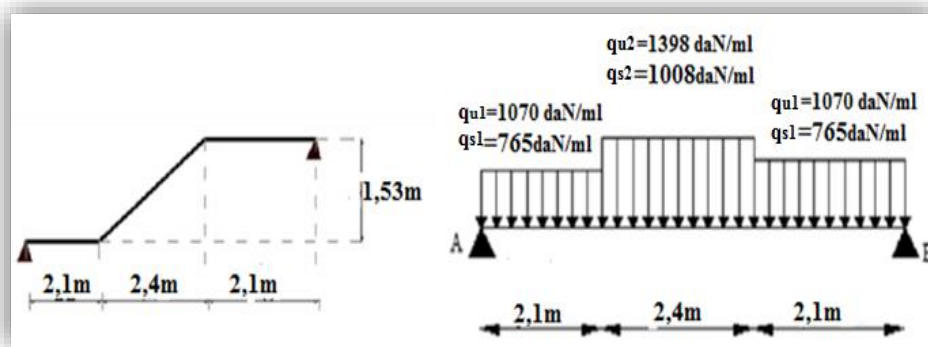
Schéma statique d'un escalier à paillasse avec palier de repos
